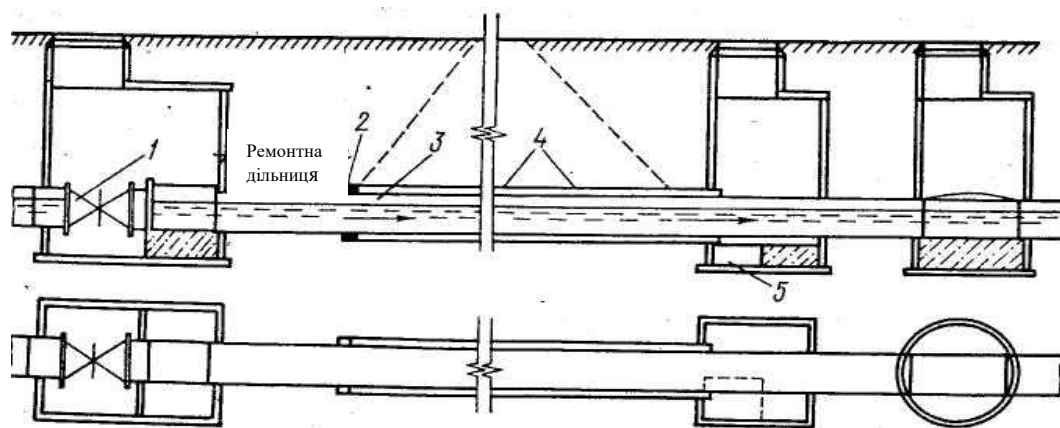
Схема переходу самотечного колектору під залізничними коліями або автомобільною дорогою:
